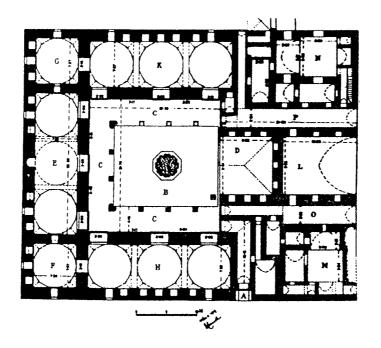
مسقط أفقي لمدرسة كومشتكين في بصري (عن: آصلان آبا).
